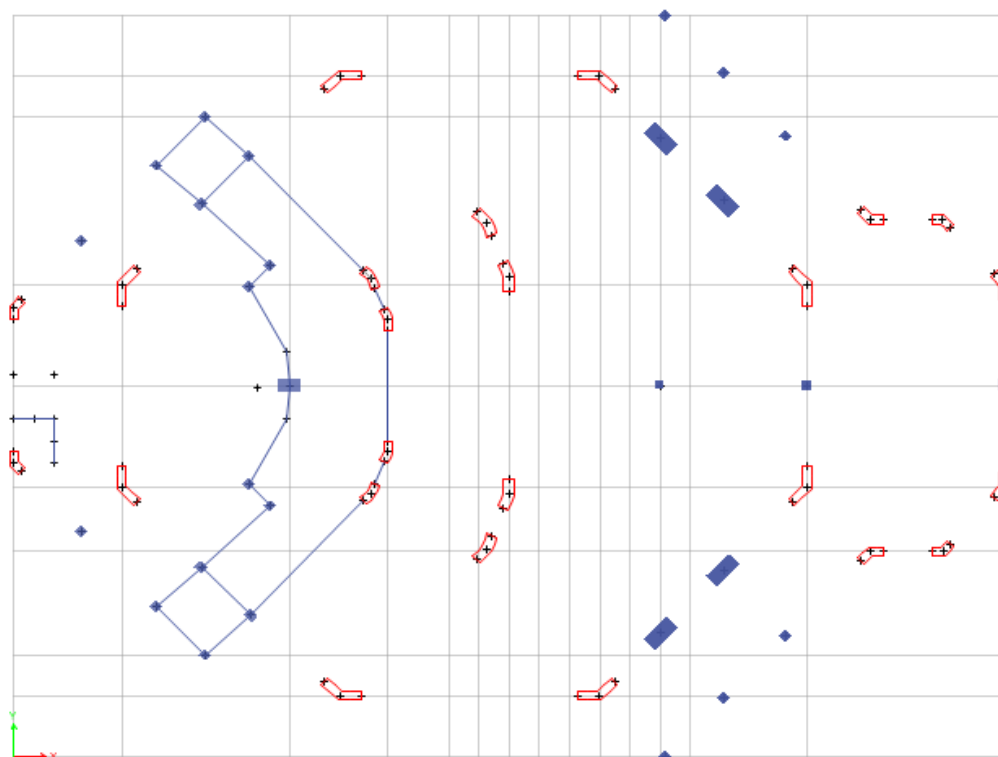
Vista en planta Auditorio – Zona media de alta circulación y escape
